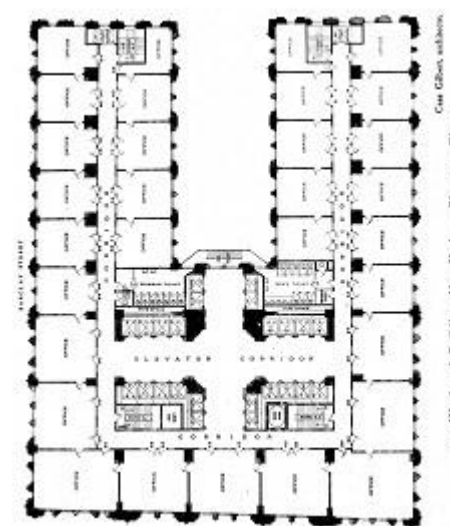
Planta típica del *Woolworth Building*, en 1910.
